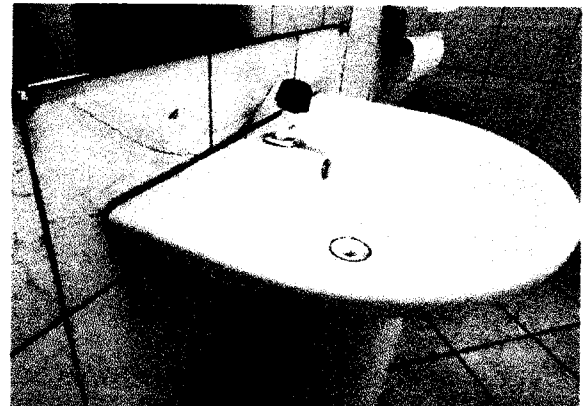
DETALHE DO LAVATÓRIO DO BANHEIRO PNE DO PAVIMENTO TÉRREO.
